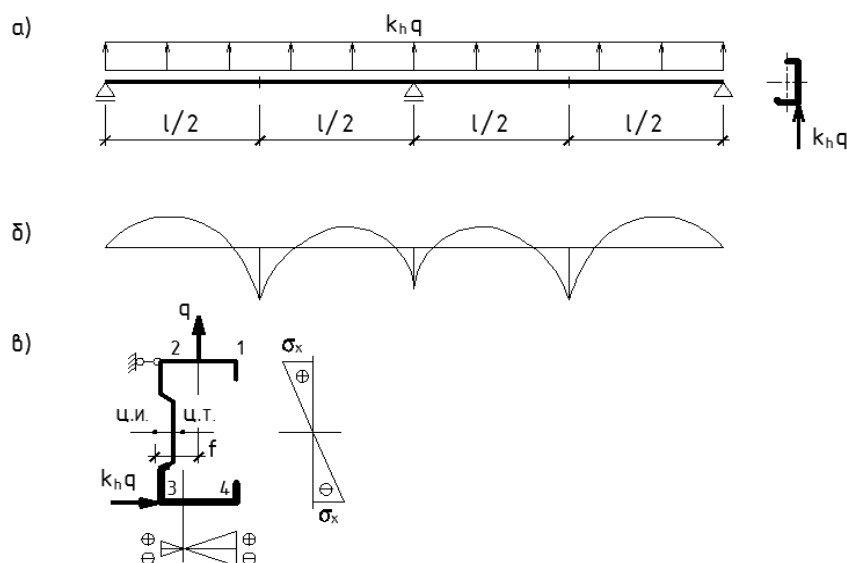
Расчётная схема нижнего пояса при изгибе под действием равномерно-распределённой боковой нагрузки (вертикальная нагрузка направлена вверх) (а);
